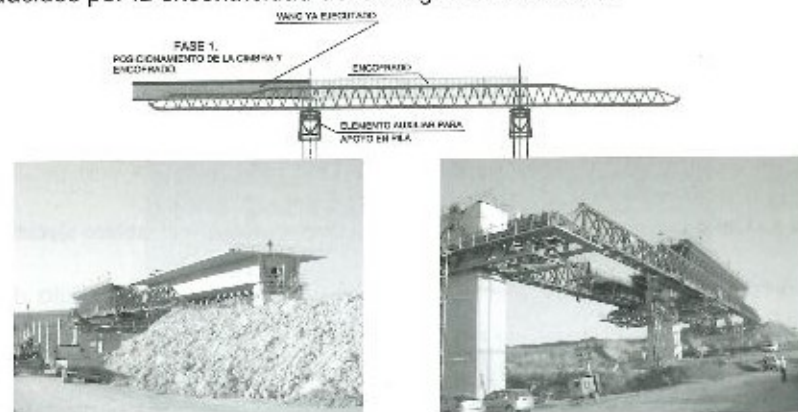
Primer vano ejecutado y avance de cimbra y encofrados
